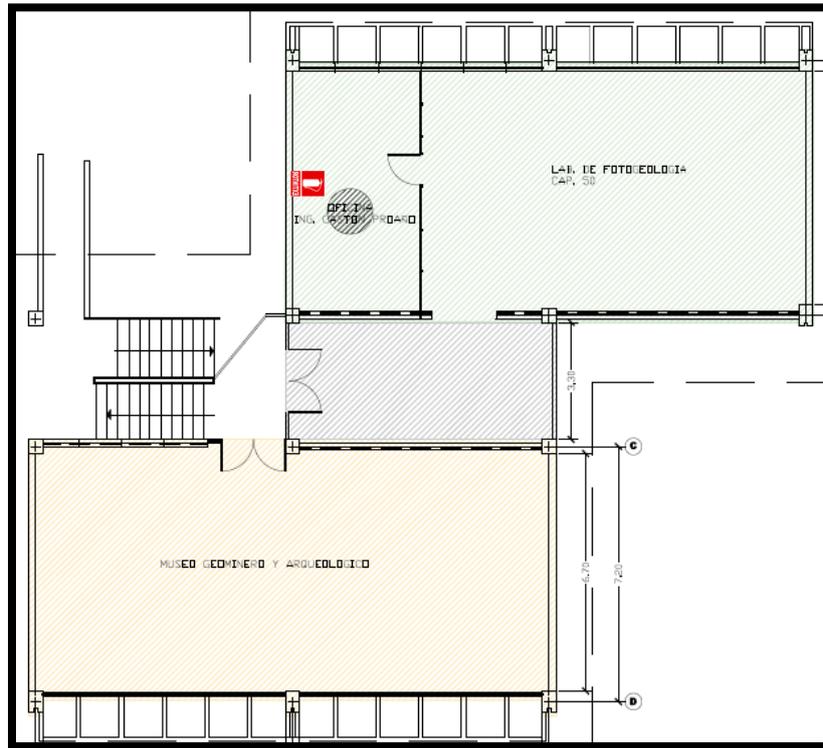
Extintores, planta alta, Edificio 20-A, Zona 1
